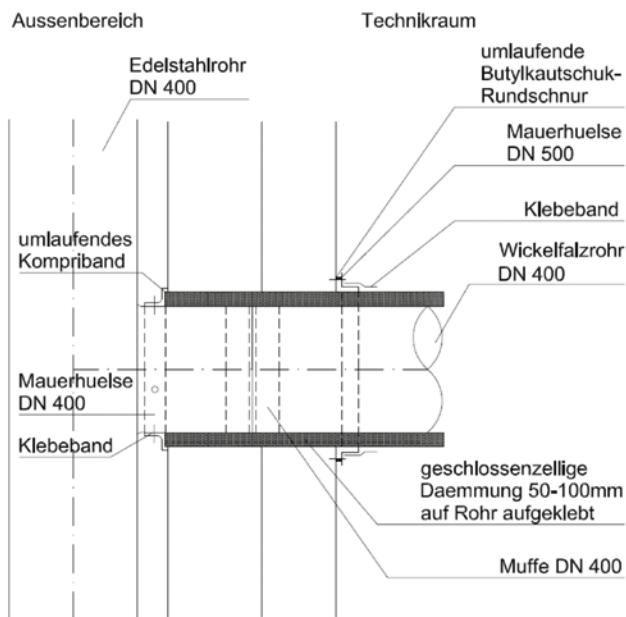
Horizontale beispielhafte luftdichte Rohrdurchführung durch eine Stahlbetonwand (bei Geräteaufstellung im warmen Bereich) [Schöberl & Pöll GmbH]
